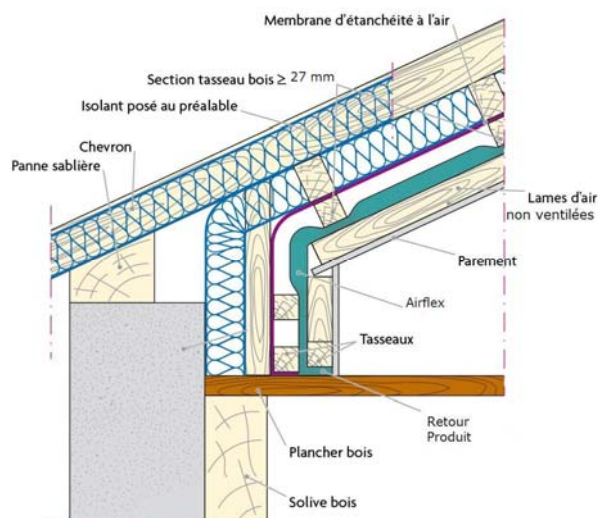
Raccordement sur plancher de comble avec 2 lames d'air
